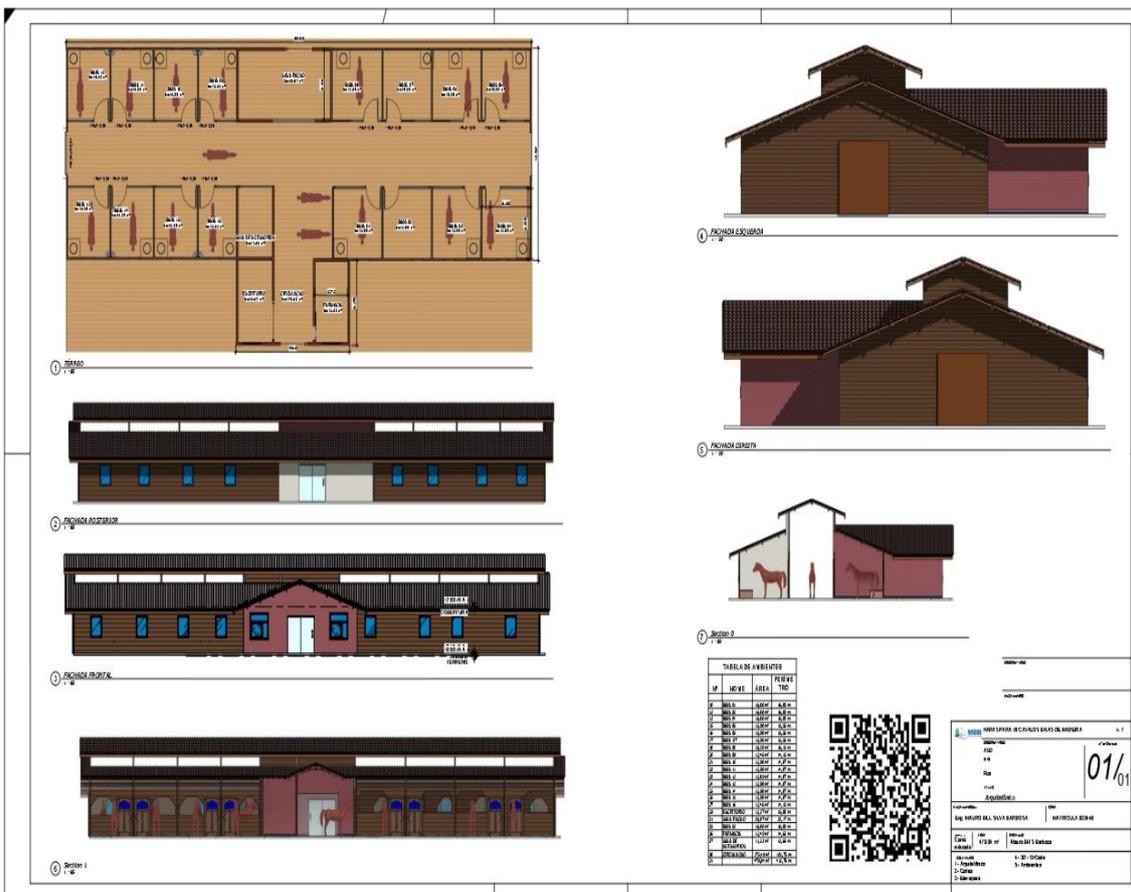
Projeto Arquitetônico Haras Cavalos Baias de trava e piso concreto
